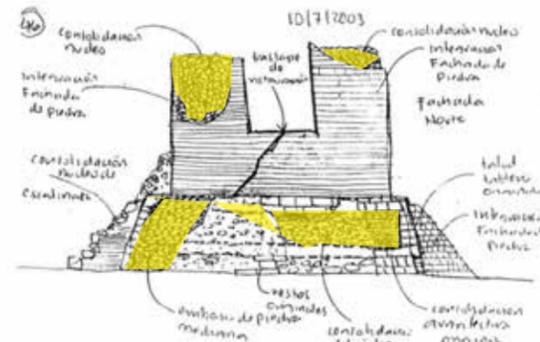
Dibujo Edificio 1 Fachada norte, Cámara superior y basamento. Restauración de muros inferiores de la cámara superior. Consolidación de núcleo y basamento. Detalle de talud-tablero de basamento. Dibujo: GAMH 2002
